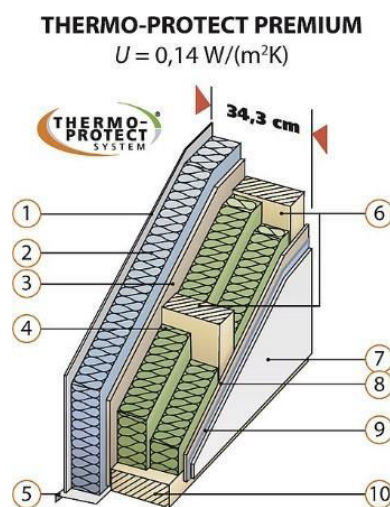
Detail W výřezu. Zdroj: Haniš, 2016
